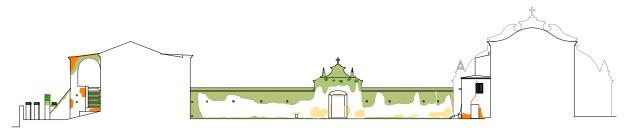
Relevamiento de lesiones - Fachada interna Oeste - Primer Patio
